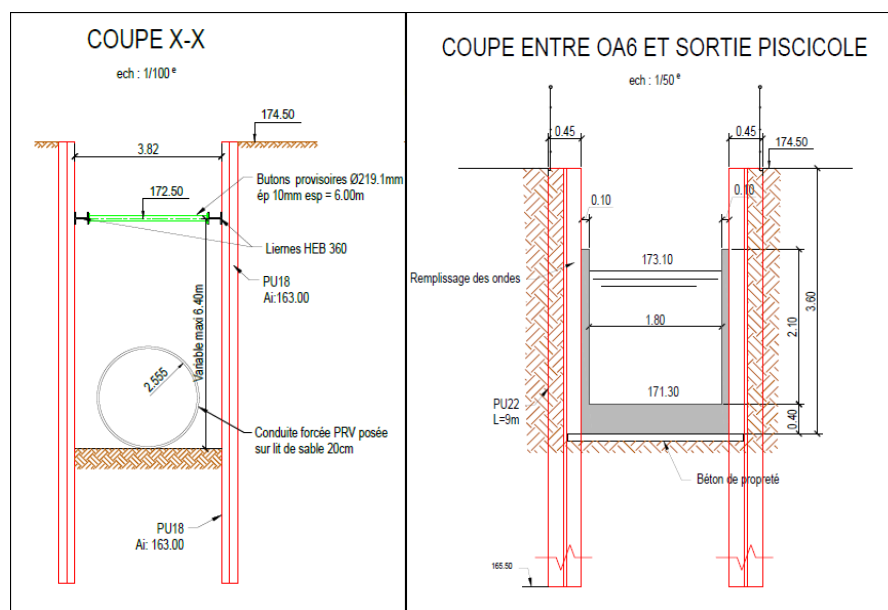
Rideaux de palplanches présents au niveau de la conduite forcée du circuit hydraulique et du canal piscicole
